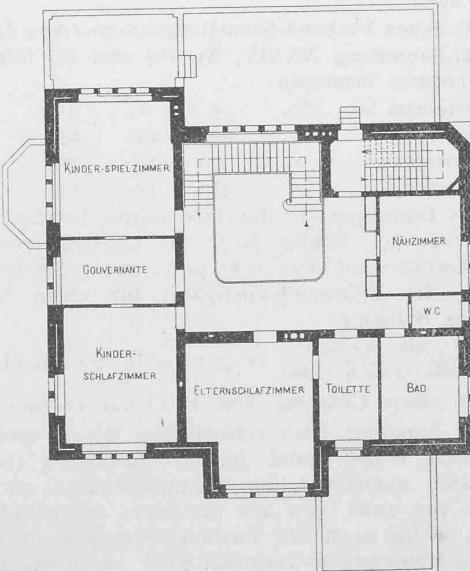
Grundriss vom I. Stock. — Masstab 1:300.
